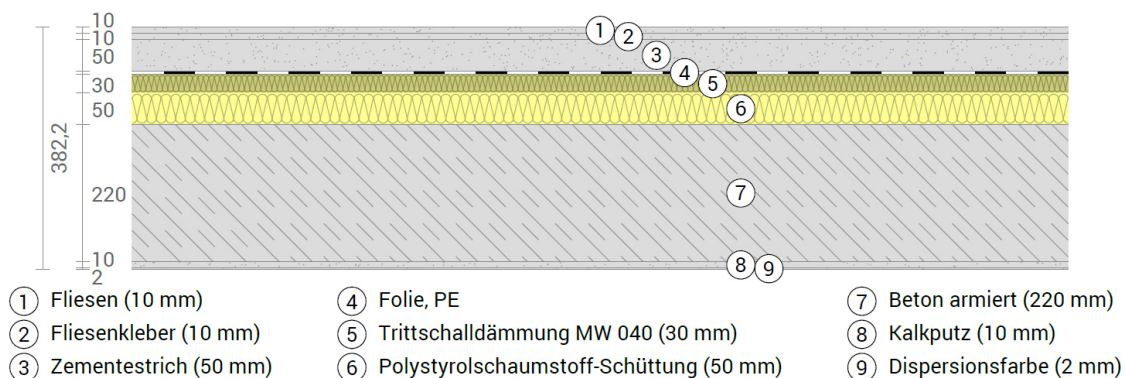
Bauteilaufbau der Geschossdecke im Verkehrsbereich (KNB-Variante)
